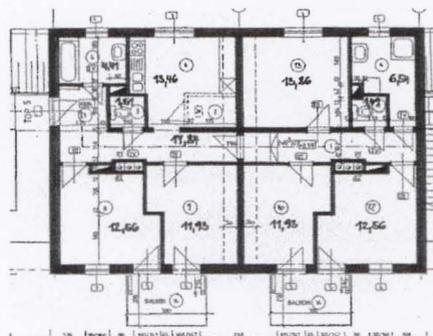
Tannhof IV Grundriss 108 m²
